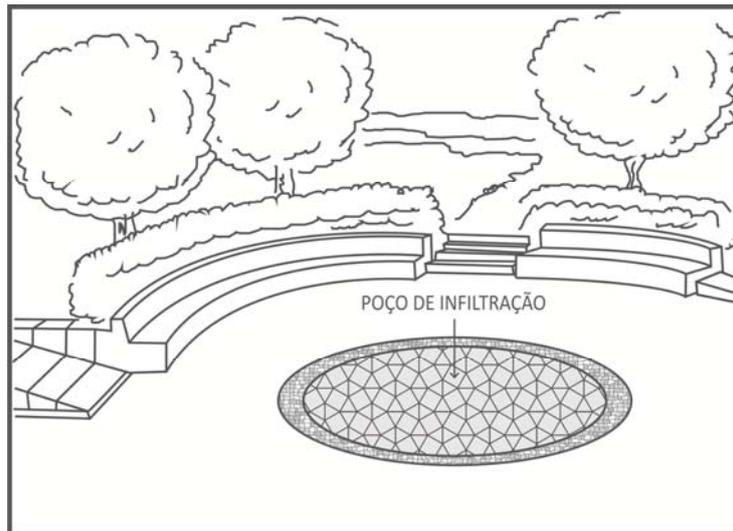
Poço de infiltração em parques ou praças (Azzout et al., 1994 - Adaptado)
